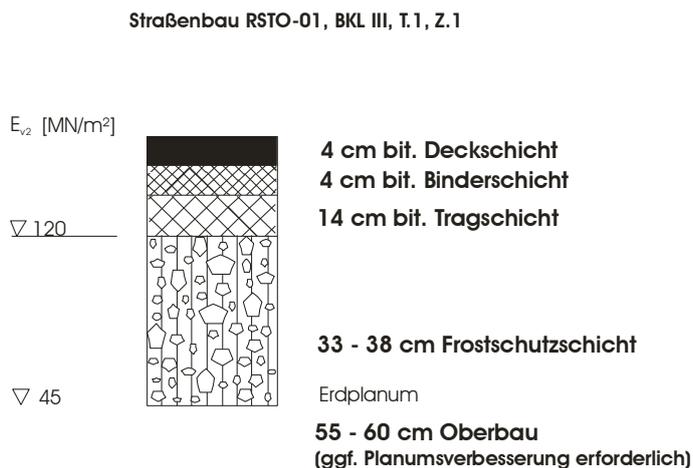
Beispiel einer Bauweise mit Asphaltdecke für Bauklasse III gemäß RStO 01
